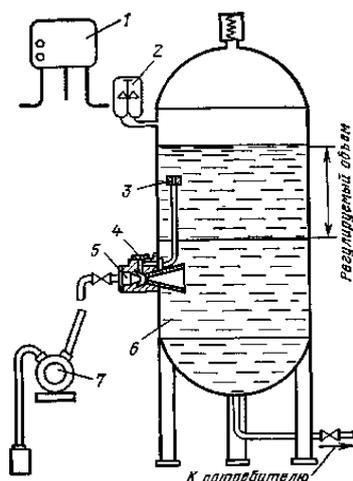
Схема безбашенной водокачки ВУ-5-30:
